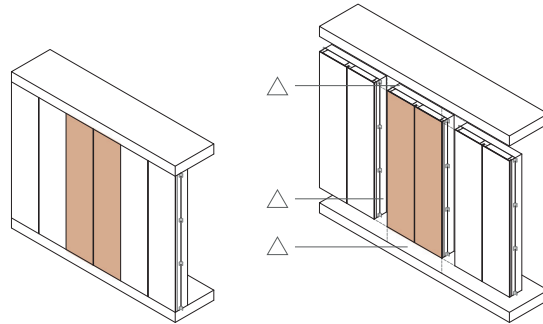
Unión panel SATE básico con fachada existente. E 1:150
